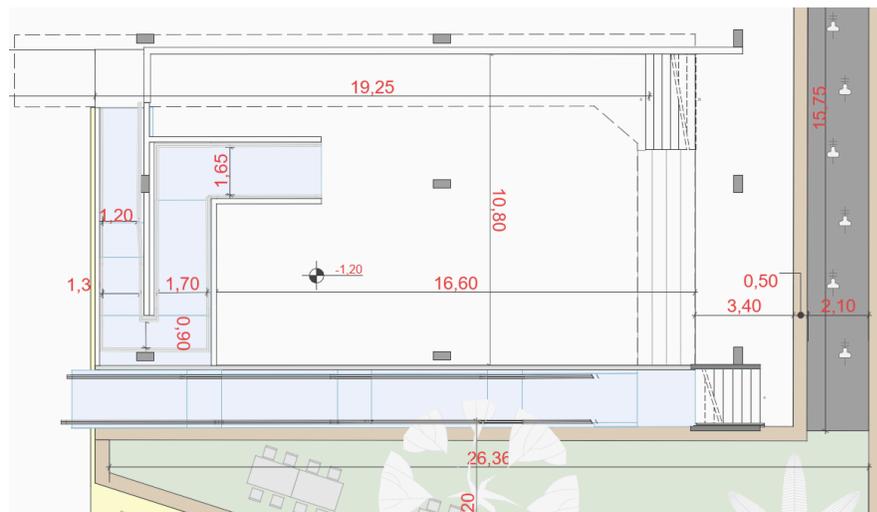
Detalhe Planta Baixa Espaço Flexível
